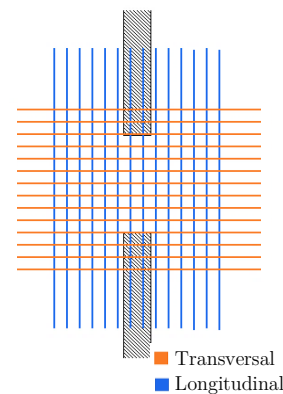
Plano de losa – Sistema de Muros T (Modificado de Henríquez, C. 2019)
